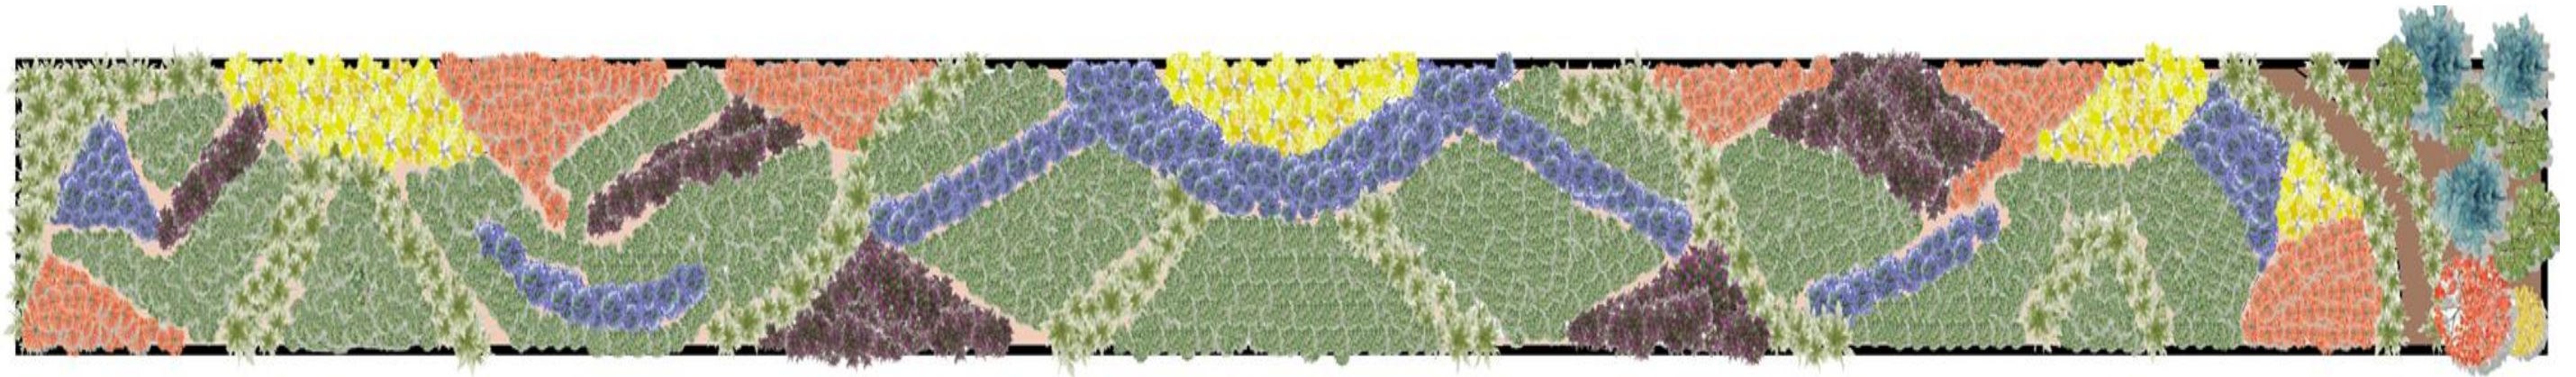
Plano de plantación y siembra. Sector "A". Fuente: creación propia.
